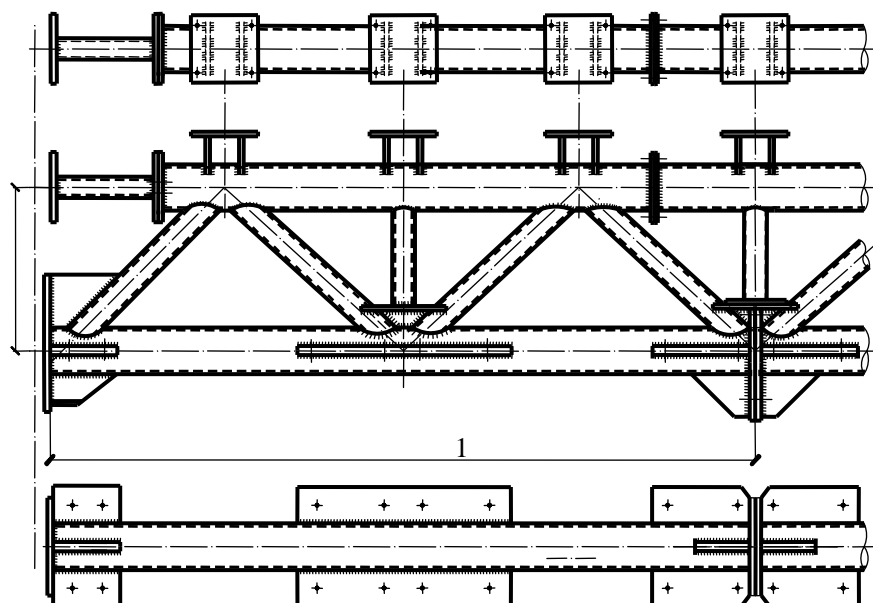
Кроввяна труобетонна ферма прольотом 24 м
